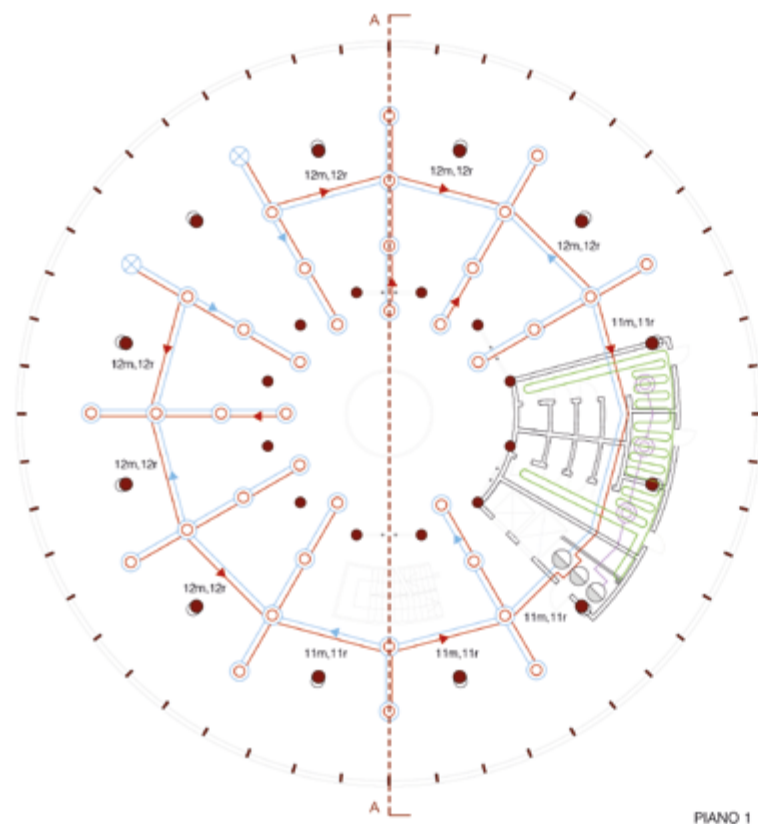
PIANA PIANO 1 E SEZIONE IMPIANTISTICA BLIOTECA
